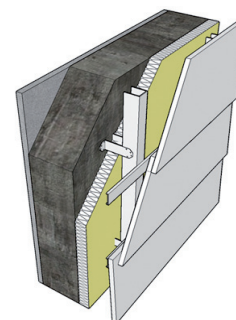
Solución Muro N°4 Muro de hormigón armado de e : 200 mm con estuco interior de e : 25 mm y sistema de fachada ventilada en estructura metálica, con aislante térmico de lana de vidrio en rollo, en diferentes espesores, cámara de aire ventilada y revestimiento exterior de tablillas de fibrocemento tipo Siding.
